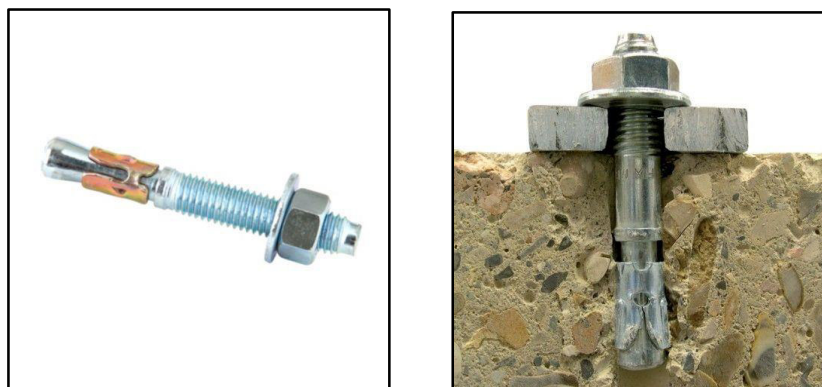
Perno de Anclaje tipo Fixser (fuente www.sodimac.com.pe)
